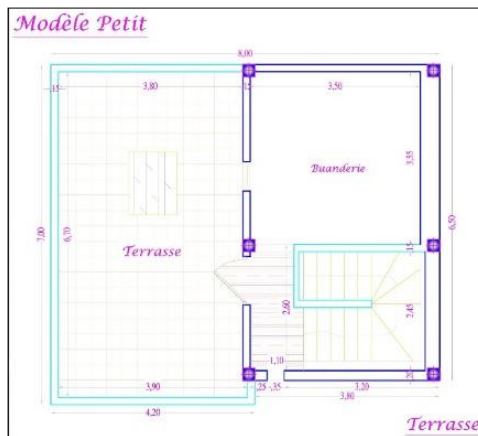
plan de Terrasse type petit. source : fondation amidoul
